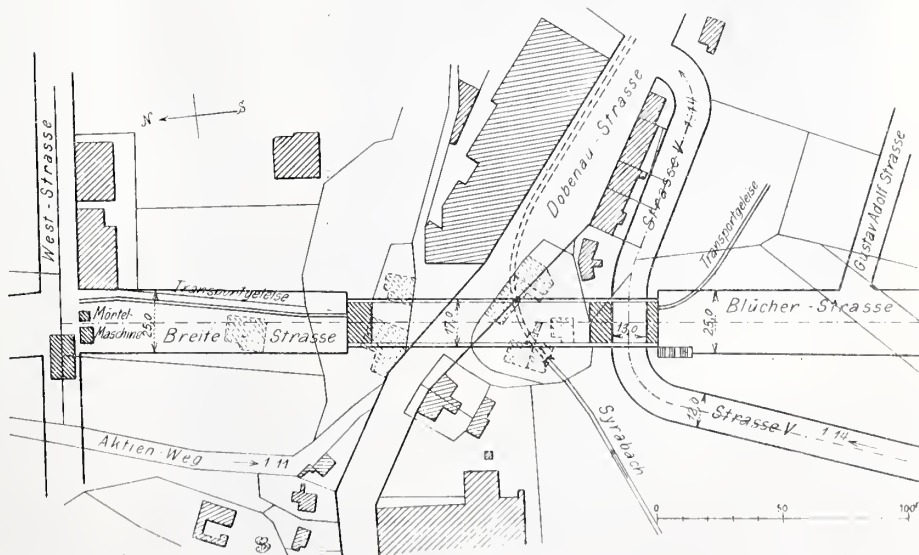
Lageplan der Umgebung der Brücke. — Masstab 1:3000.
